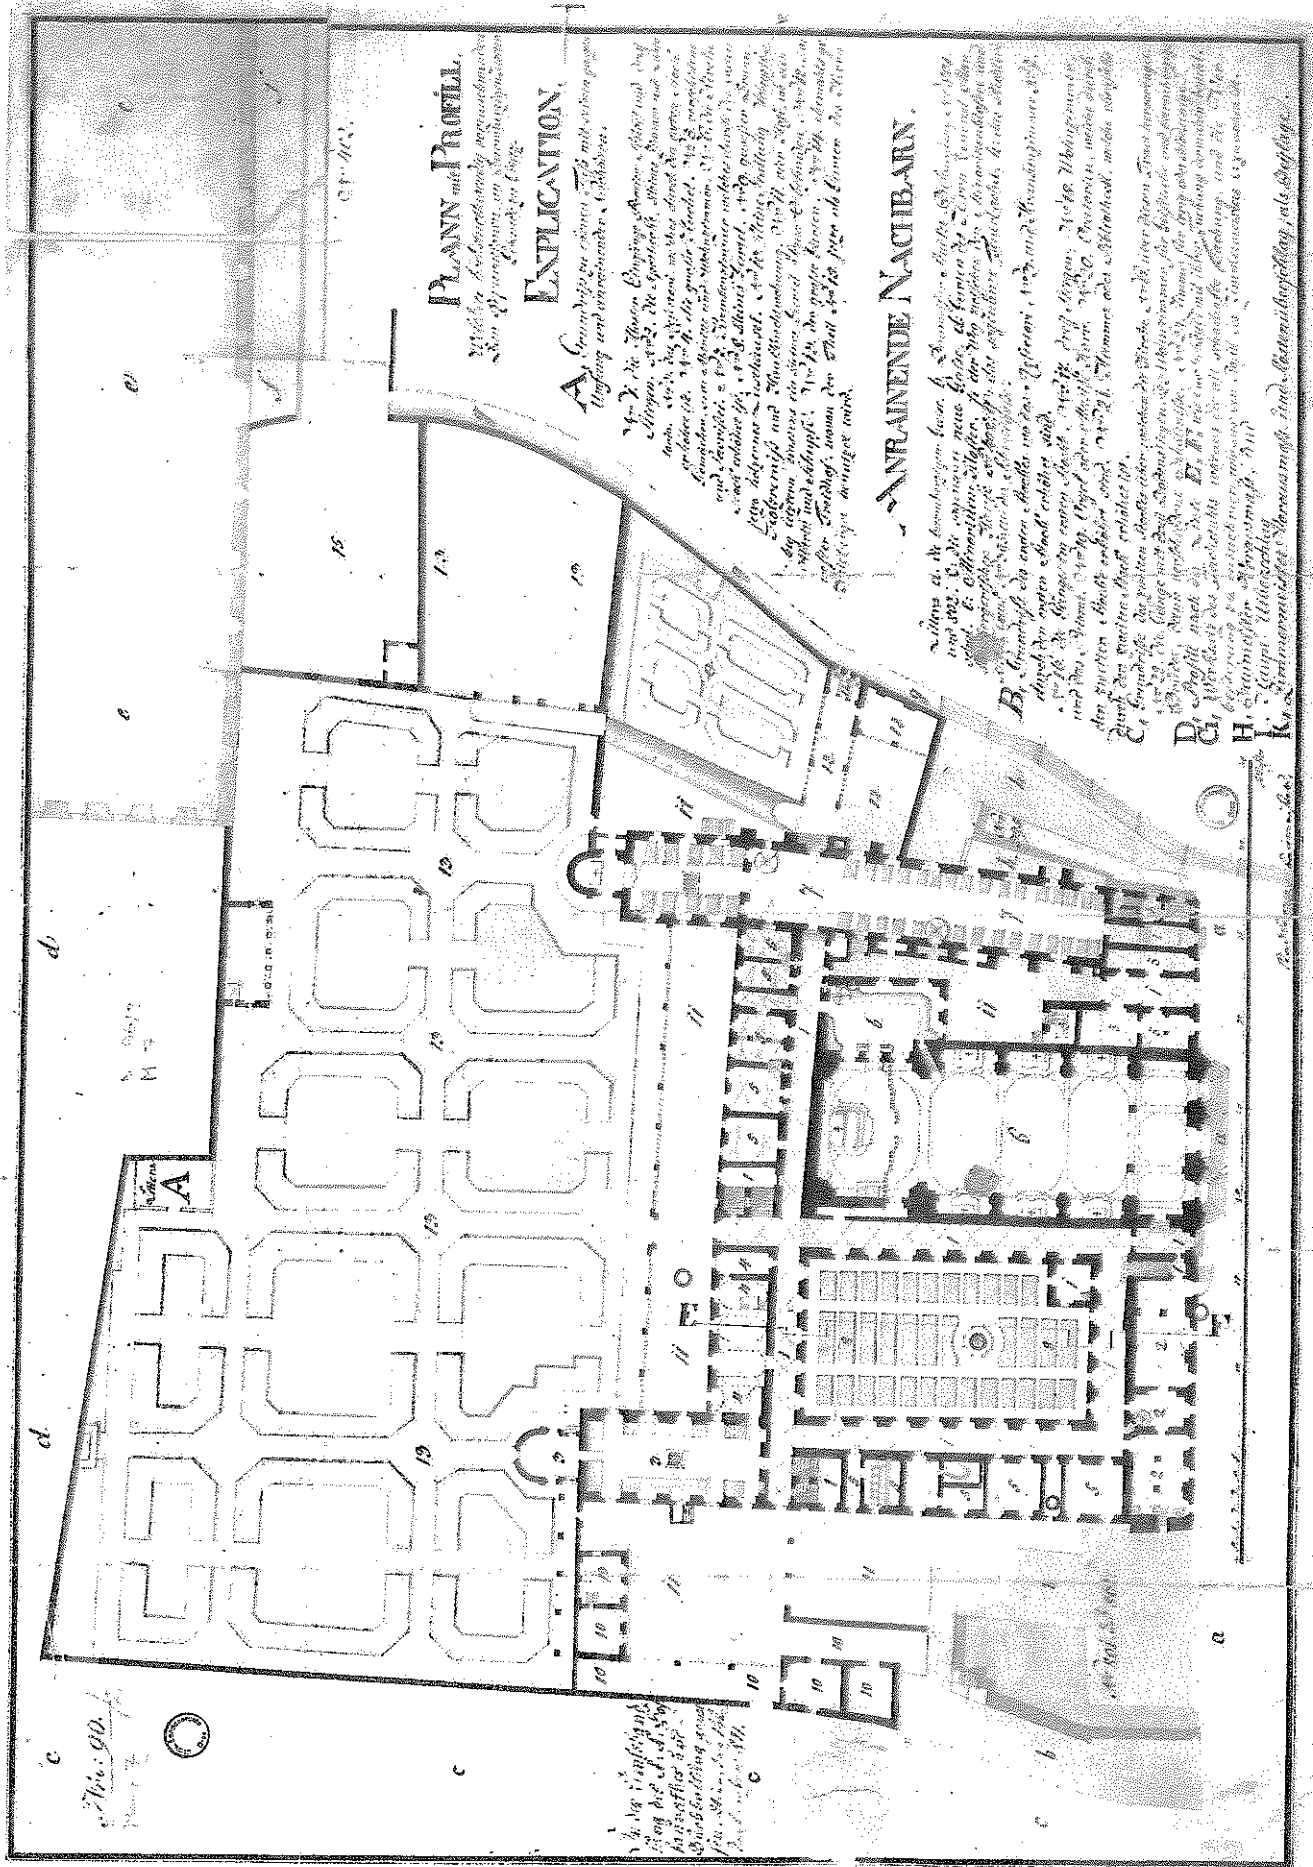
Christoph Stadler, Kloster und Spital der Barmherzigen Brüder mit Barmherzigenkirche, Zeichnung, um 1811, Grundriss Erdgeschoss.
